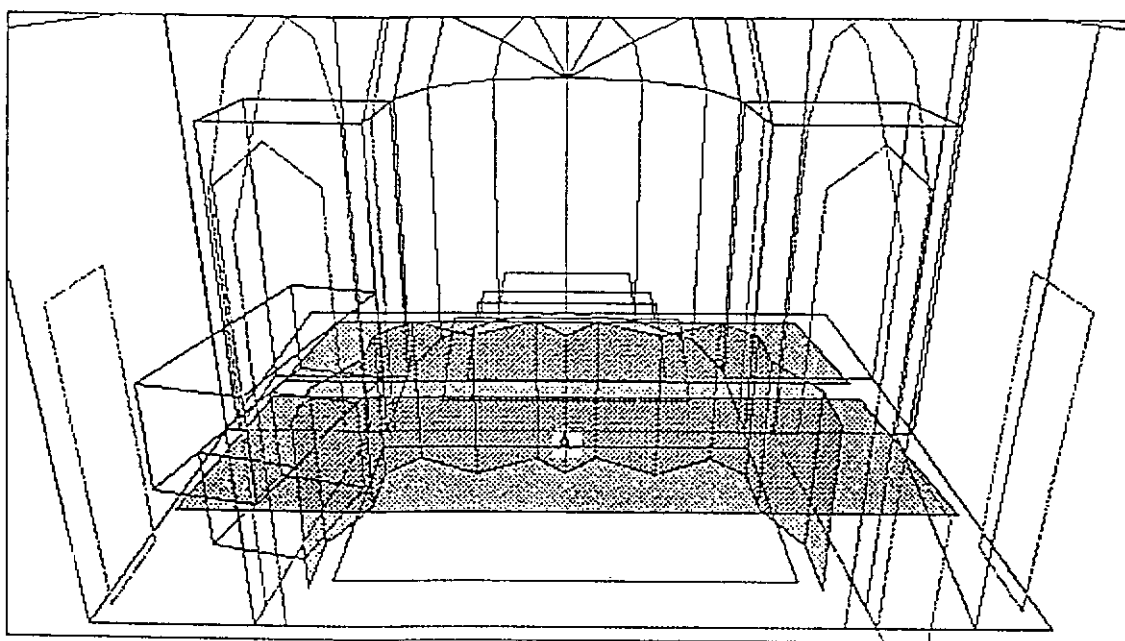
Ipotesi di allestimento "E". Vista prospettica dall'interno.
